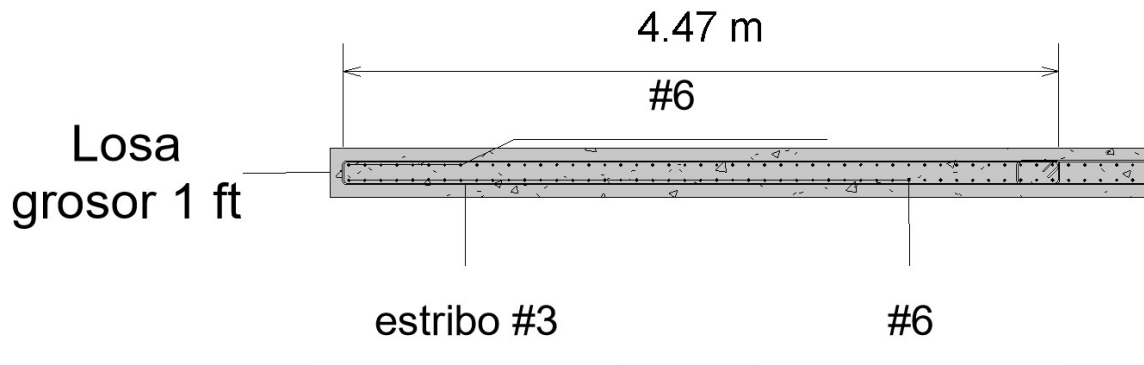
Detalle del refuerzo longitudinal de la losa interno de alcantarilla de una celda.
